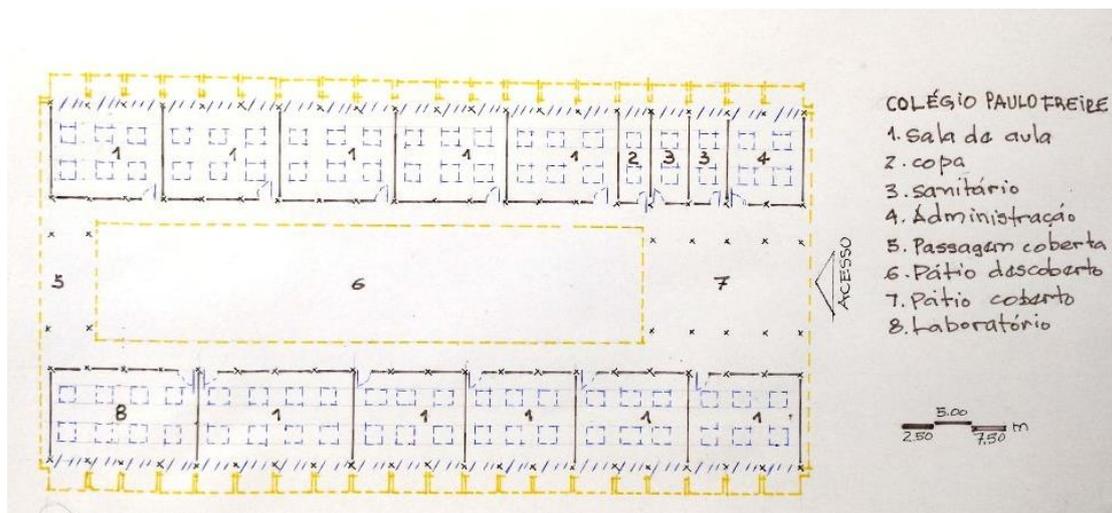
Planta esquemática do Colégio Paulo Freire. Imagem do autor, 2021.
